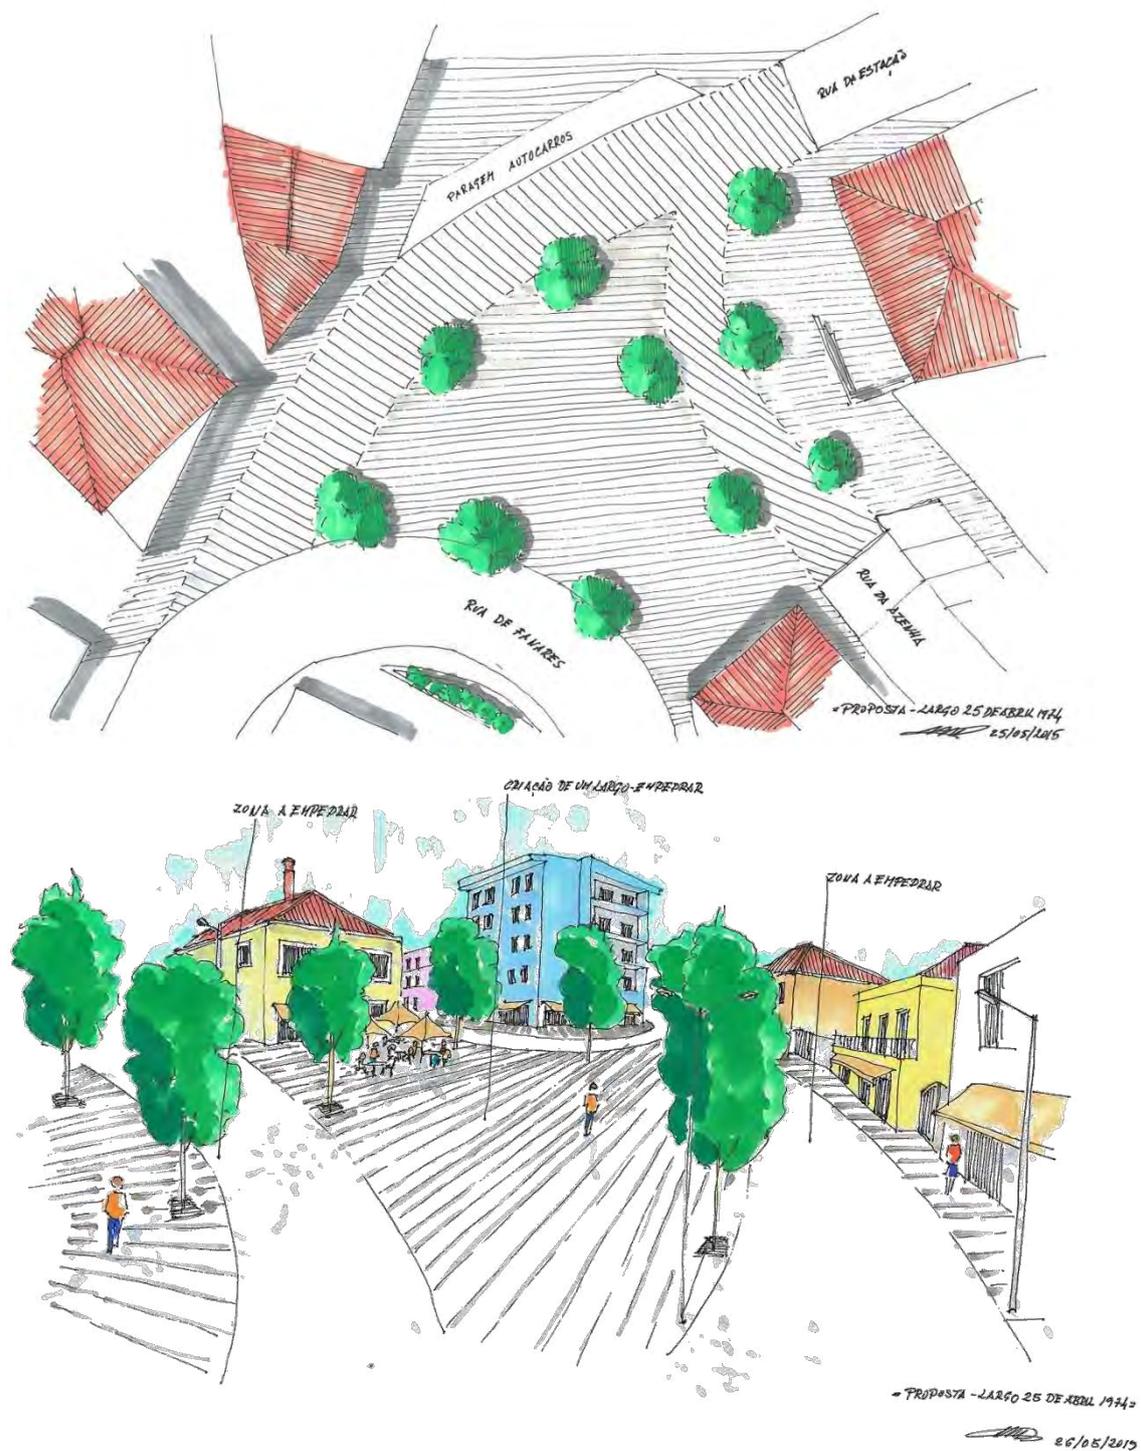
Planta de intenção de desenho urbano alternativo e uma perspetiva possível a partir da Rua da Estação
